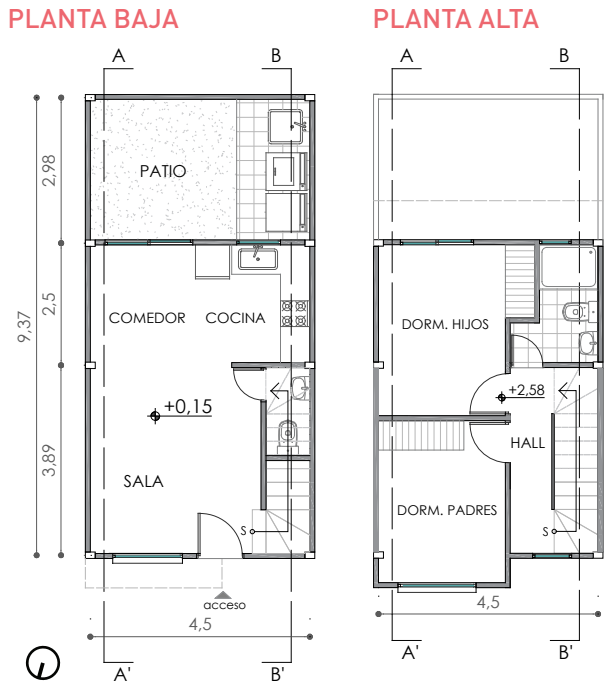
Plantas arquitectónicas vivienda adosada oeste
